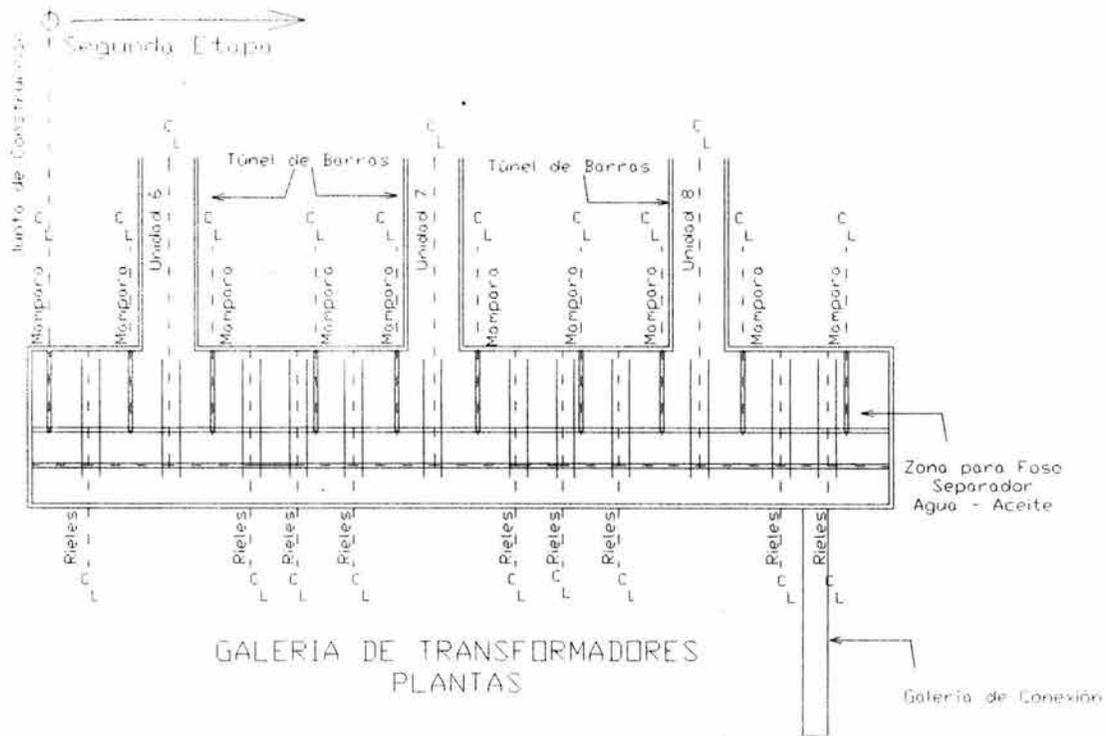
Vista en Planta de la Galería de Transformadores.
